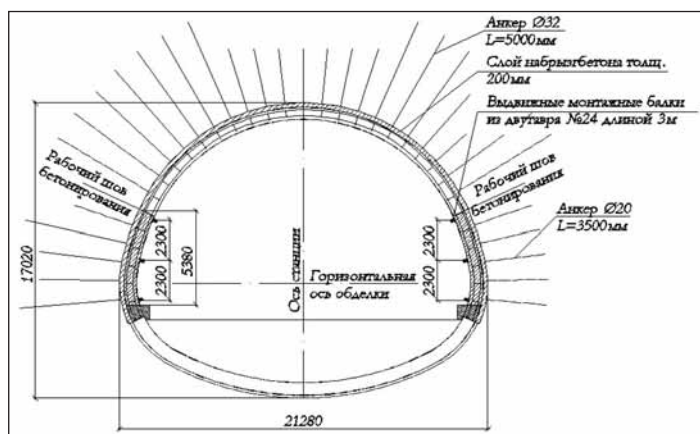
Схема бетонирования стен с поддержкой металлоизоляции выдвижными балками
